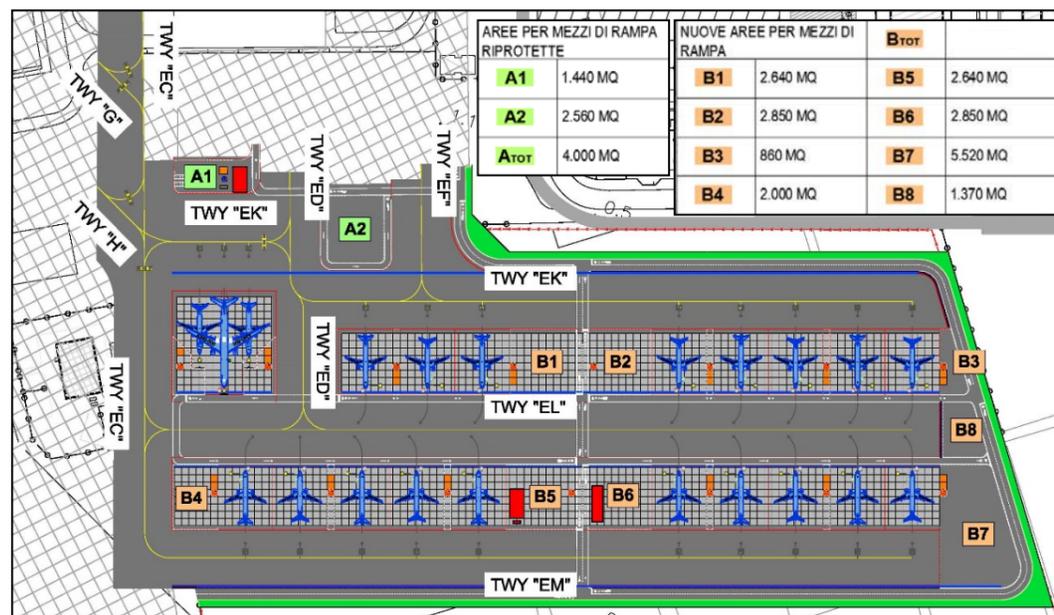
Layout dell'Apron Est con le aree per i mezzi di rampa
